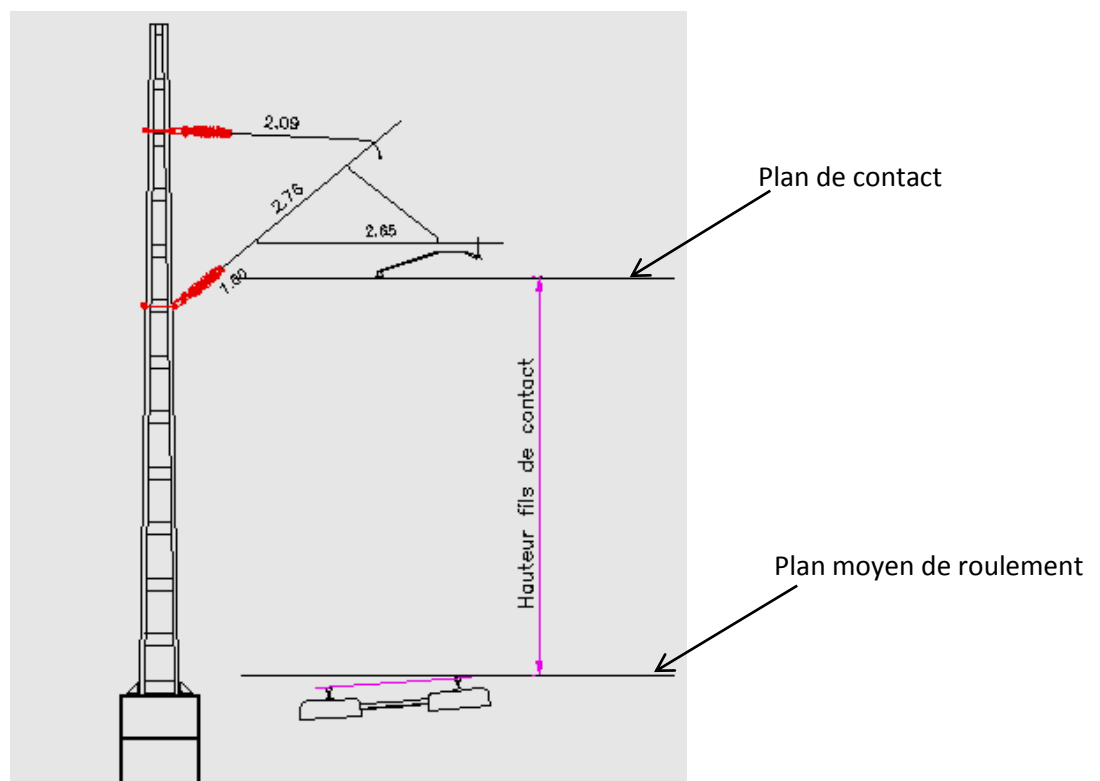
Représentation du Plan de contact et plan moyen de roulement
